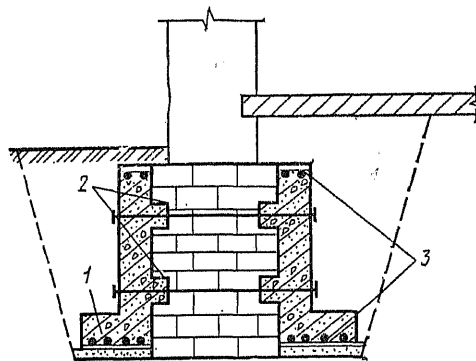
Увеличение площади подошвы кирпичного или бетонного фундамента
